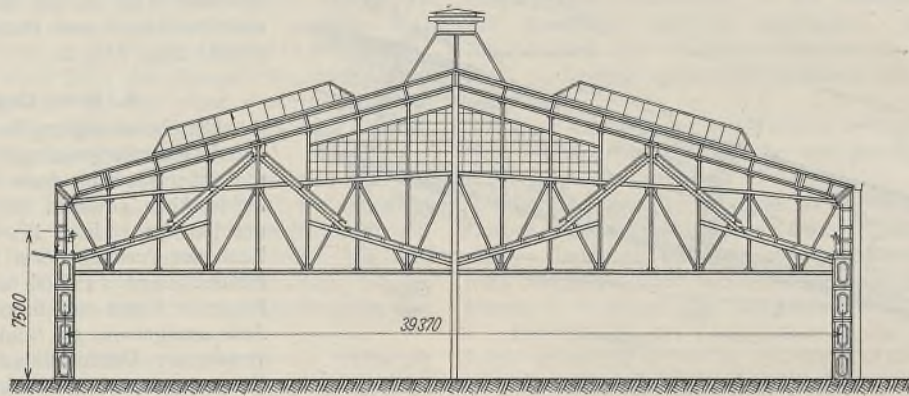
Stahlfachwerk-Giebelwand zum Anschluß gegen Hallen B u. C.
